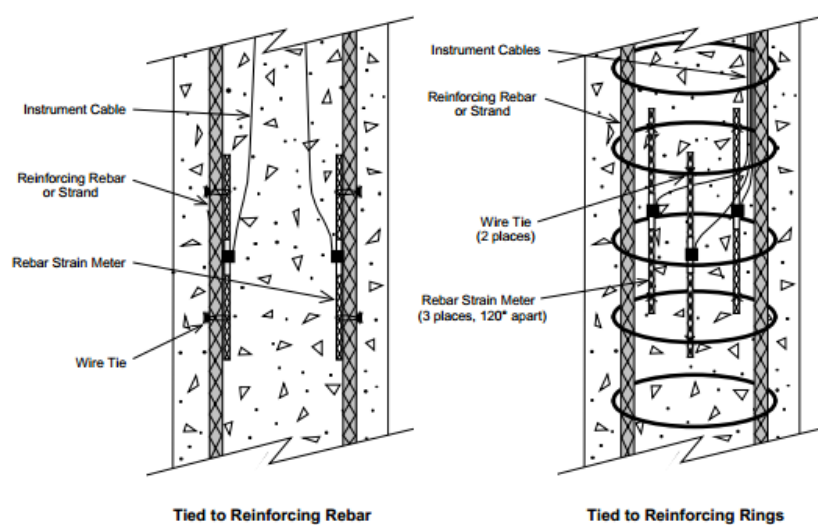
32 - Detalhe da instalação do Extensômetro modelo 4911 na armadura da estaca – Geokon
